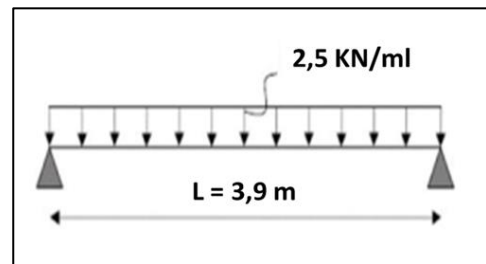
Schéma statique de la poutrelle et son chargement avant coulage de la dalle.
